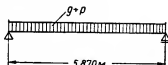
Расчетная схема настила и схема нагрузок.
